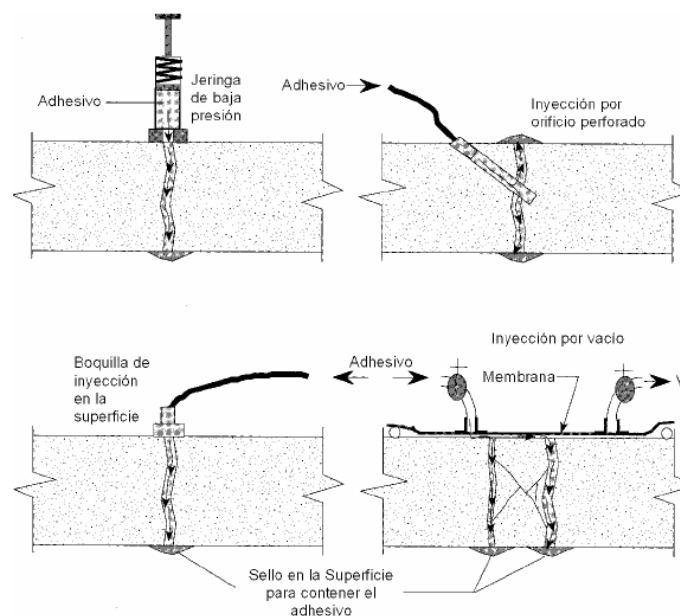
Técnicas para inyección de resinas en concreto agrietado (Alcocer, 2003).
